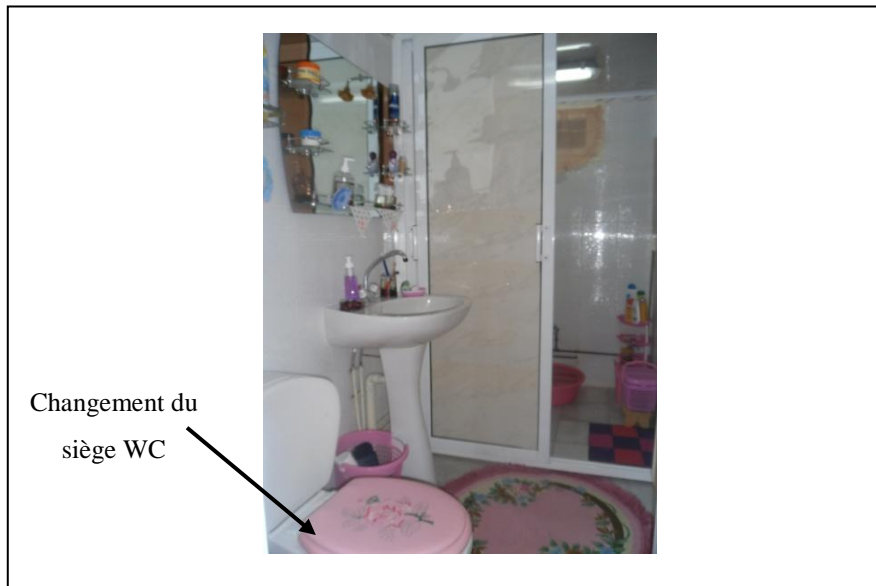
Installation d'une porte coulissante pour séparer le WC de la salle de bain
